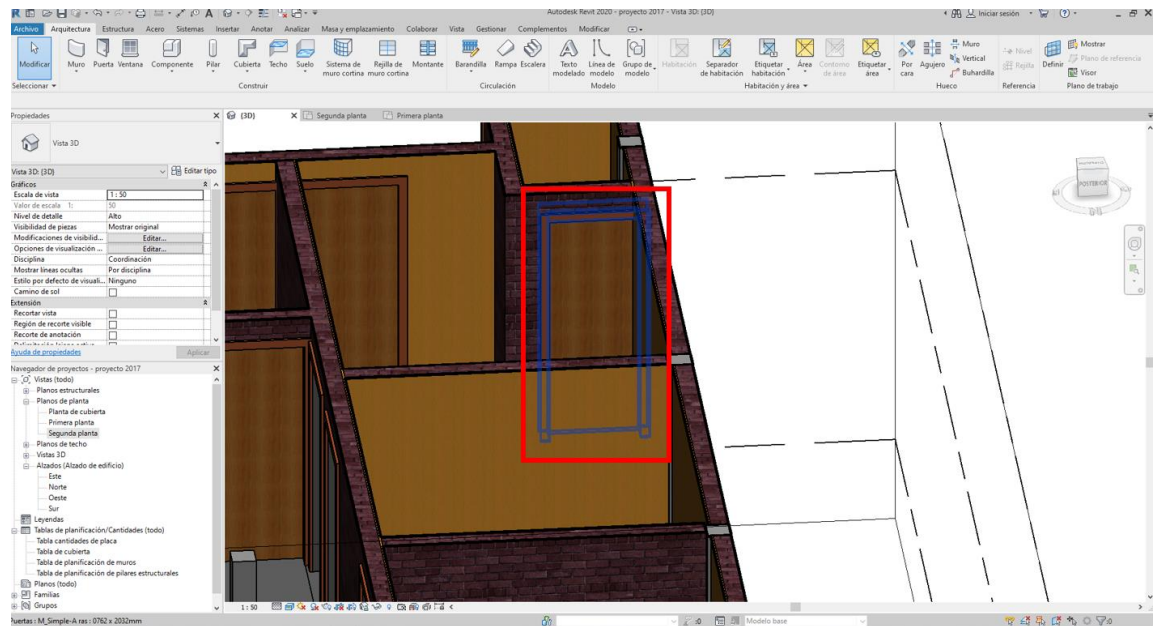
Interferencia entre puerta y muros. Revit. Fuente elaboración propia.
